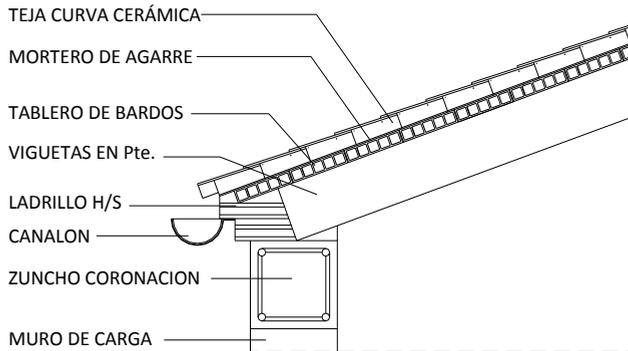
Detalle esquemático de la cubierta inclinada tipo de la vivienda.
